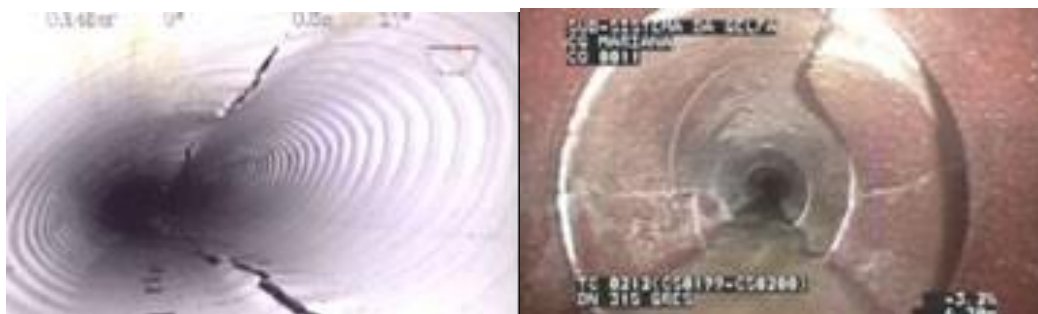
Fissuração generalizada com risco de colapso iminente (Manvia (2021)).
